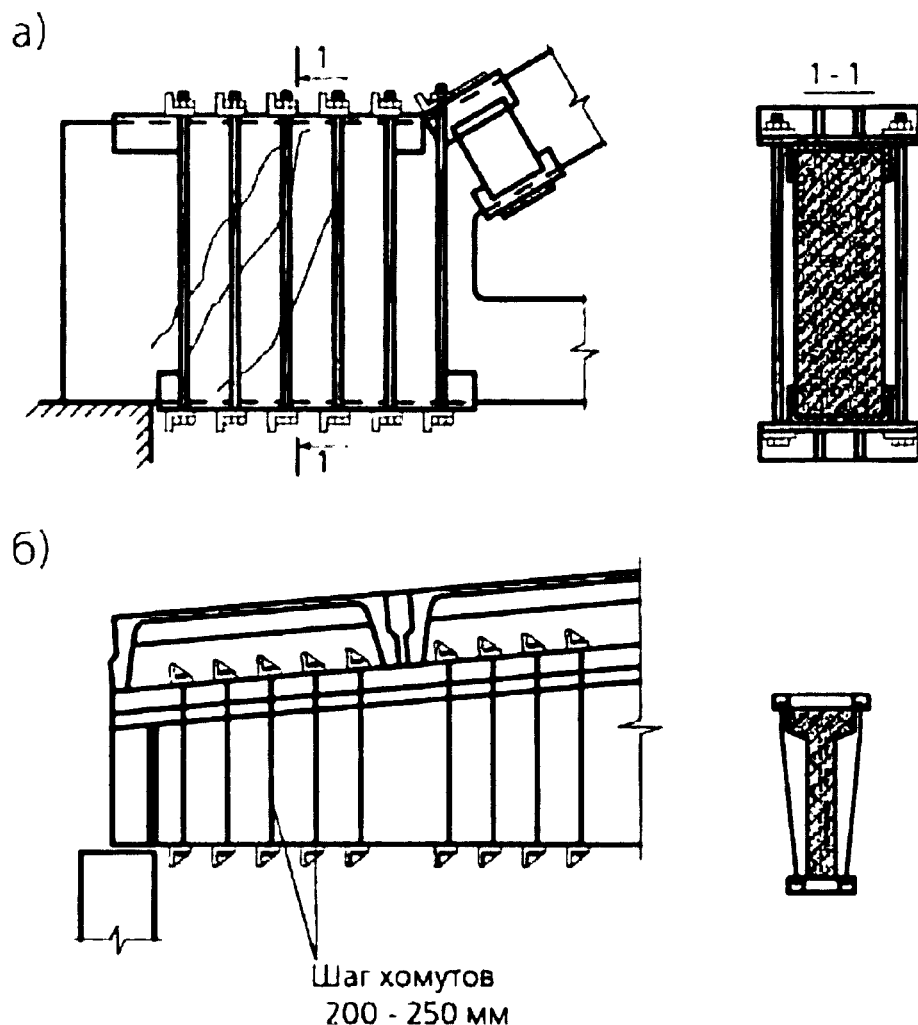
Усиление опорной части конструкций наружными напрягаемыми хомутами: а - усиление опорного узла фермы; б - усиление опорной части балки
